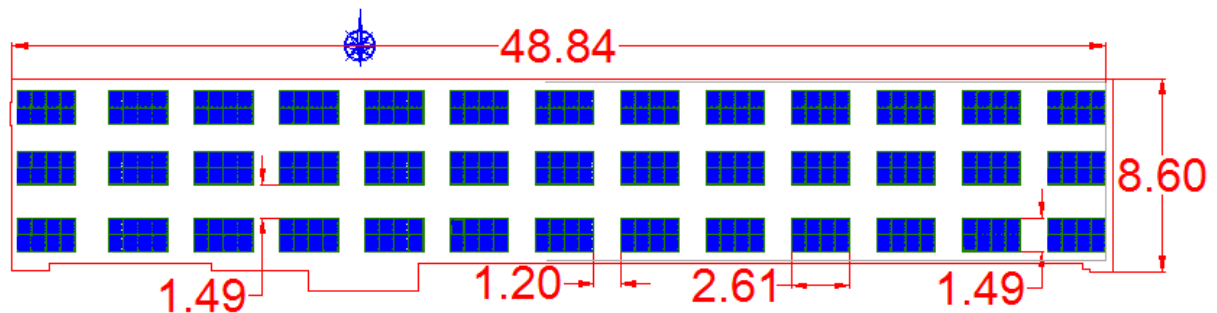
Terraza del edificio de Eléctrica, espaciamiento entre bloques.
